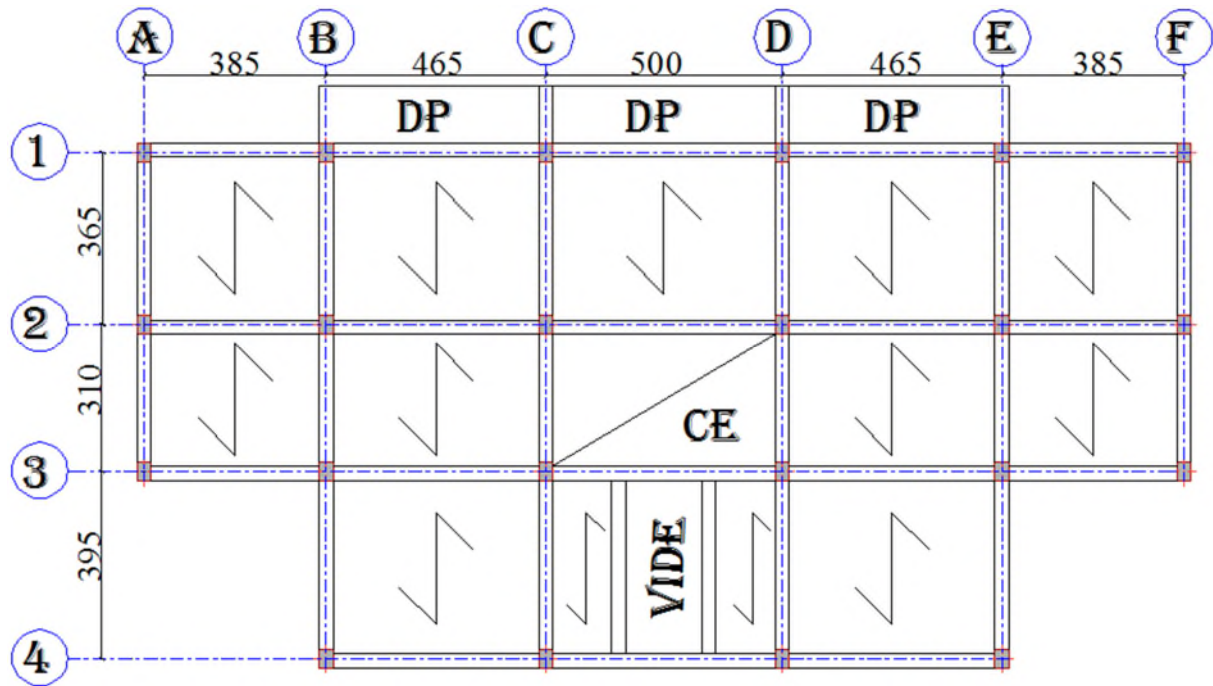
Plan de disposition des poutrelles (Étage courant).
